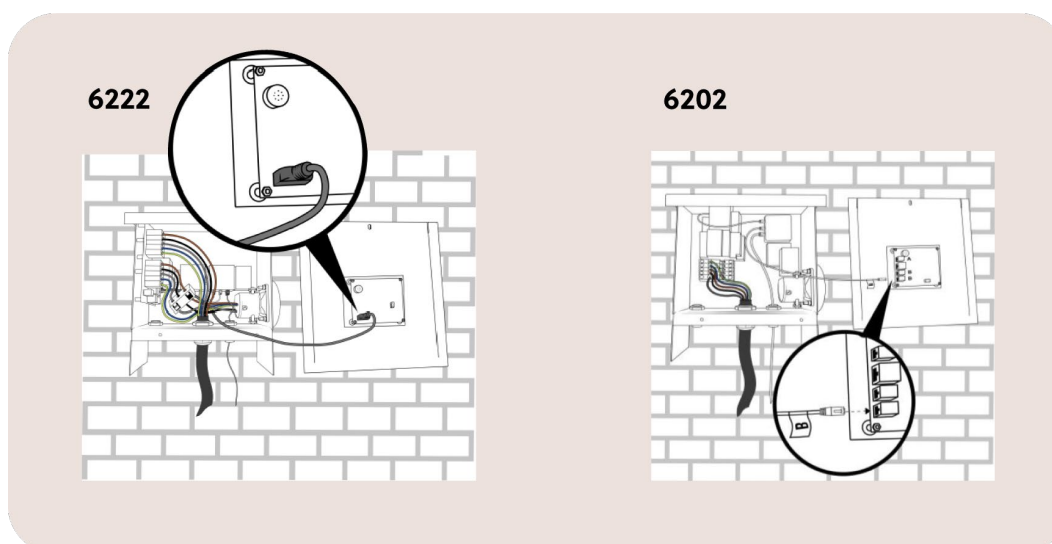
Vue sur le câble à 12 broches (6222) et le câble RJ10 sur le port B (6202) sur le circuit imprimé.
